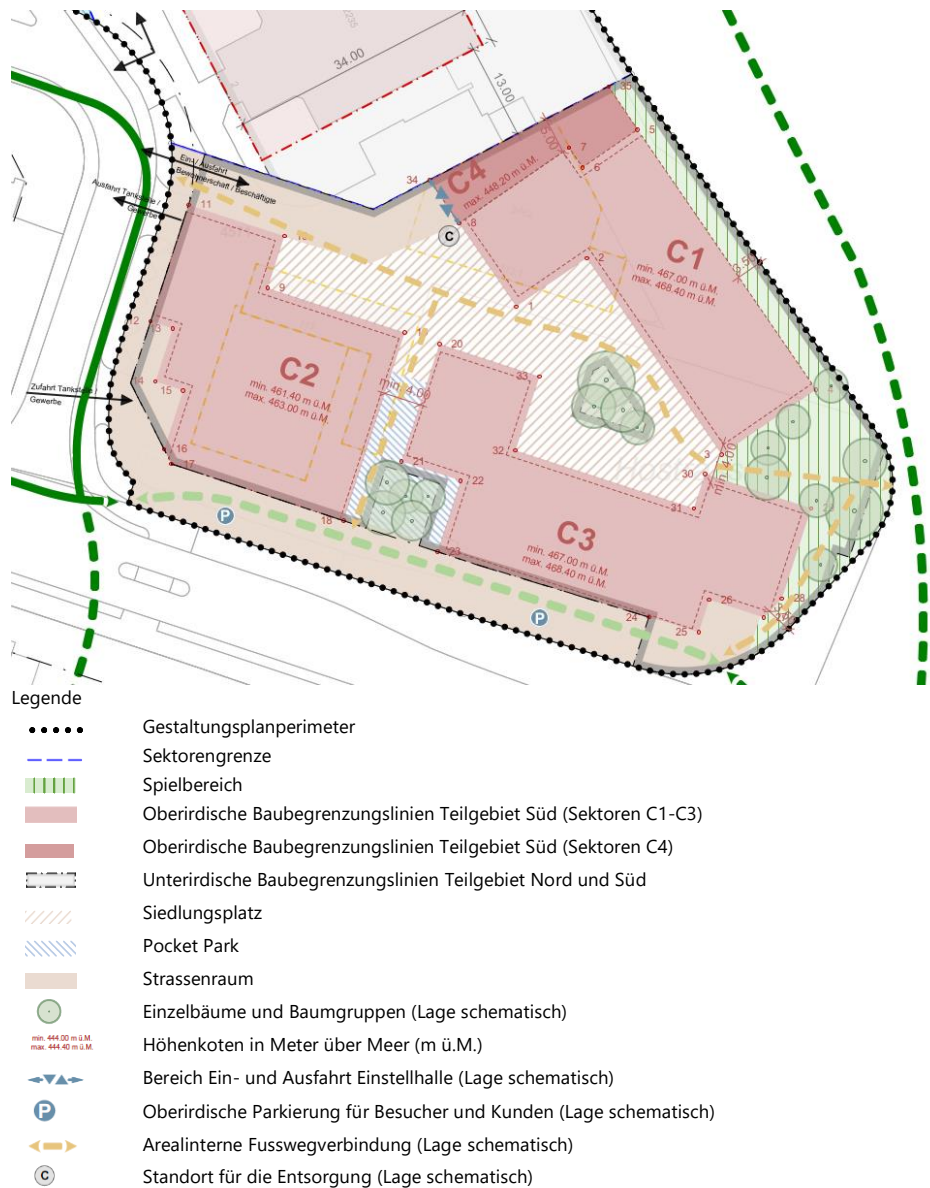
Planausschnitt Situationsplan neue Einträge für das Teilgebiet Süd
